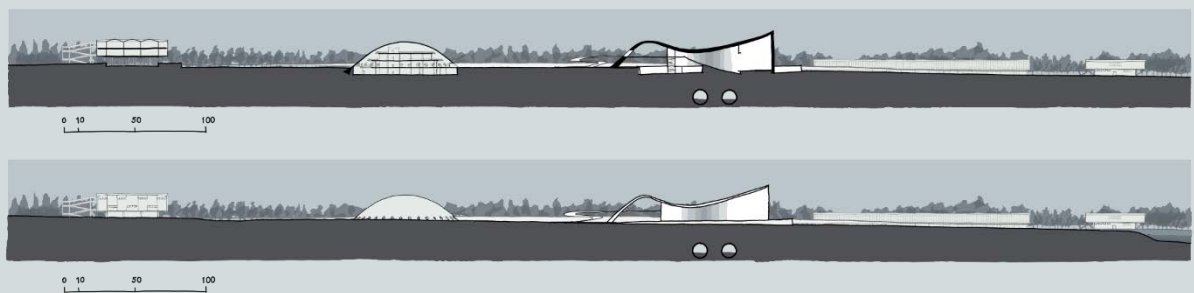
Implantação – 2002 – Versão 02 – desenho nosso.
